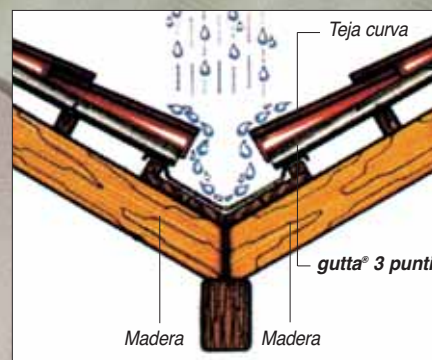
Colocar la placa gutta® 3 punti (u otra placa Gutta) clavarla con tacos de fijación TS18 para estructuras de madera
